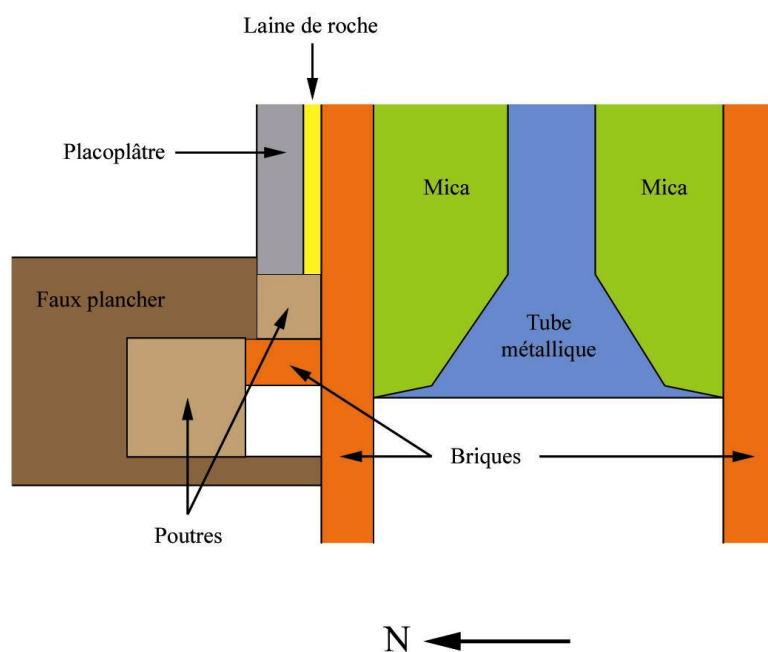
Vue en coupe, les différents matériaux présents à proximité des conduits d'évacuation des fumées lors du passage au travers du faux plancher du duplex.
